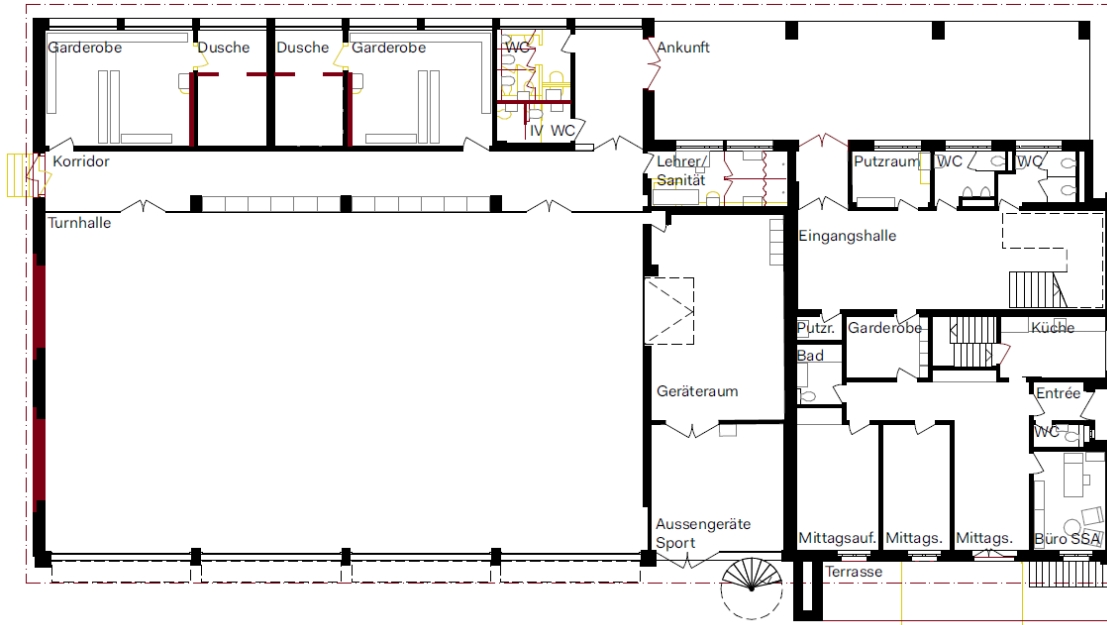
Hallentrakt – Grundriss Erdgeschoss mit Turnhalle
